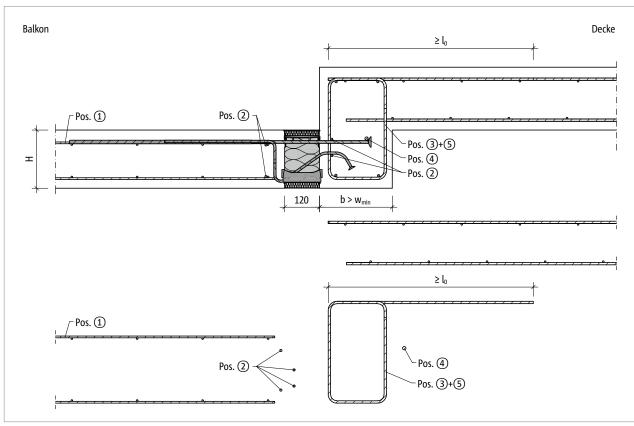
Schöck Isokorb® XT Typ K-U: Bauseitige Bewehrung für Balkon mit Höhenversatz nach unten mit größerer Bauteilabmessung ( $w_{vorh} > w_{min}$ )
